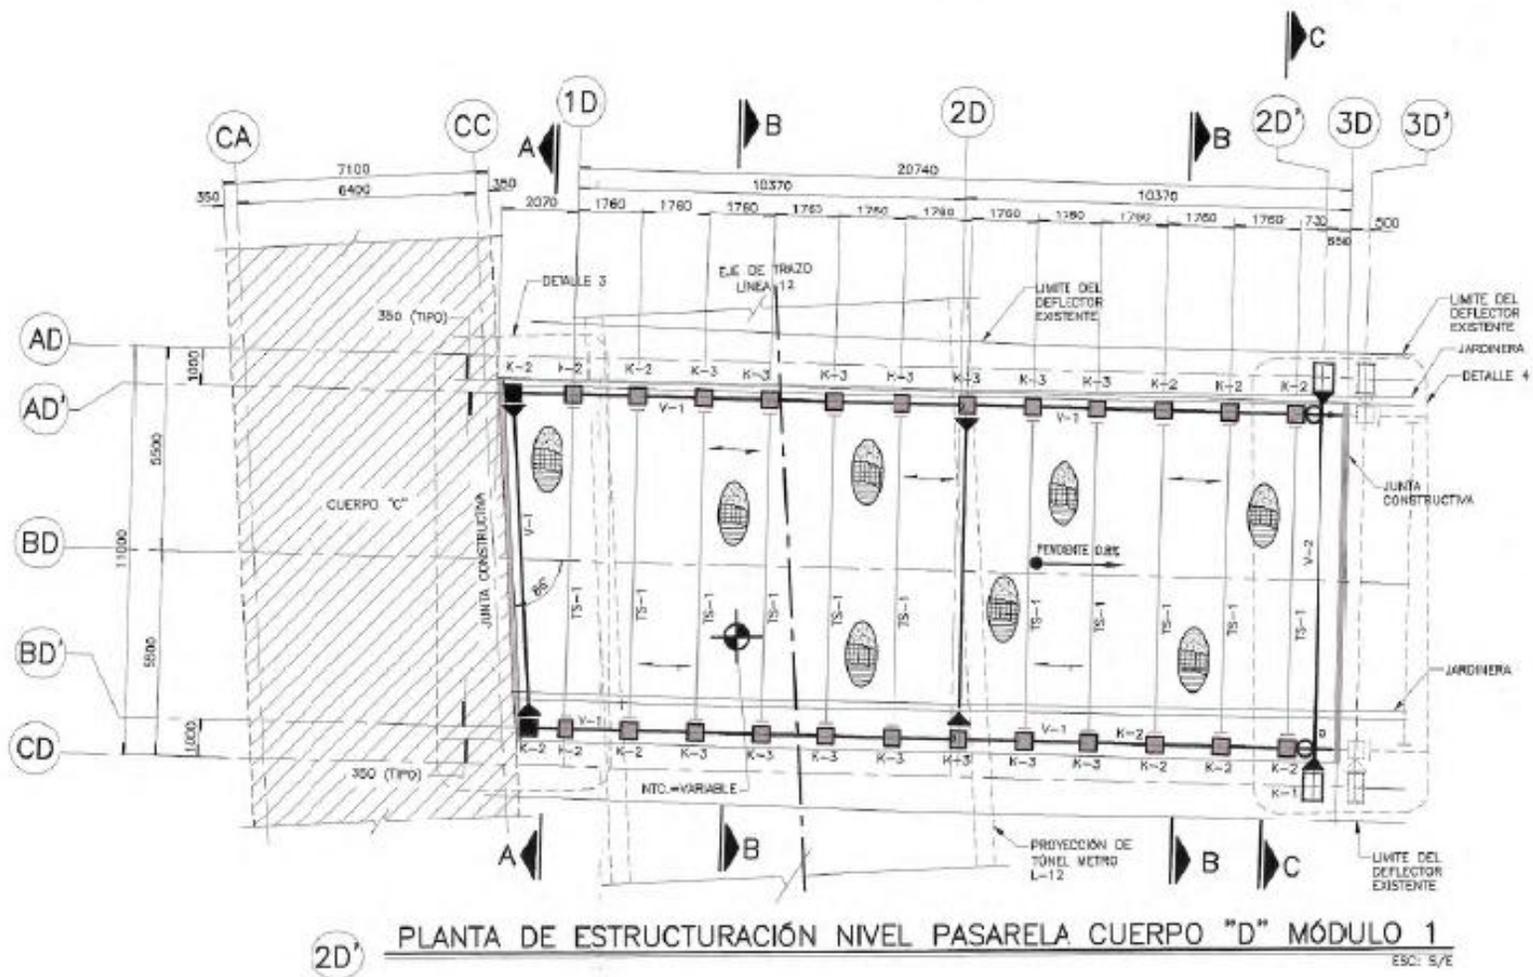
Planta de estructuración nivel pasarela módulo 1.
